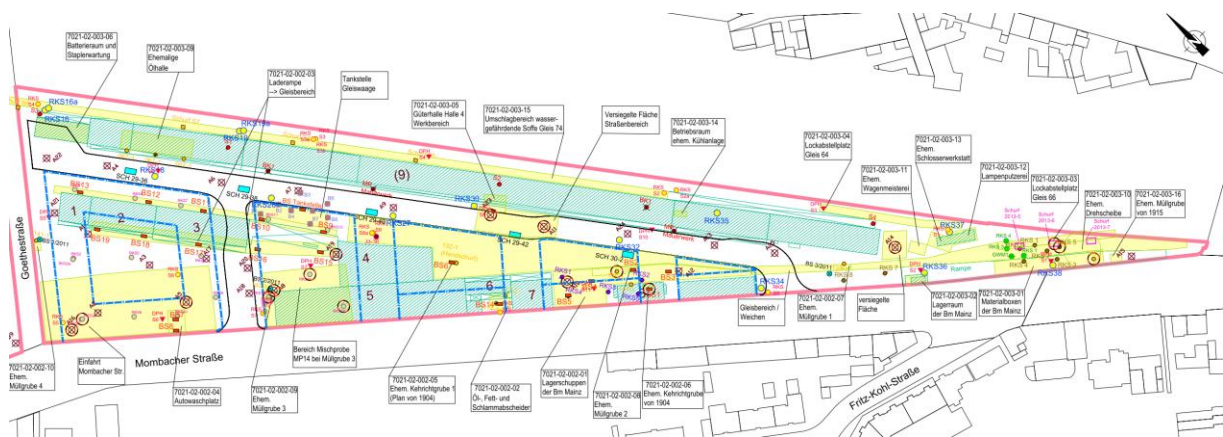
Lageplan mit Altlastenverdachtsflächen und Bohransatzpunkte 1996 - 2014
